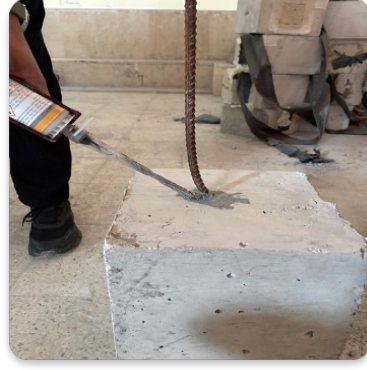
Farklı Eğiklik Açıları İle Beton Bloklara Delik Açılması
